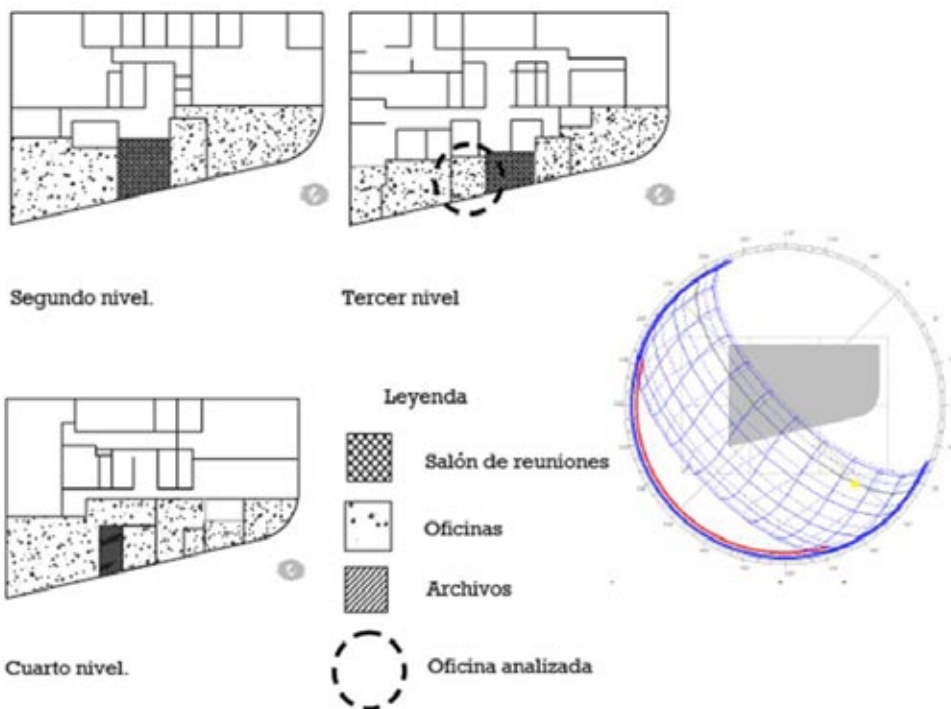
Ubicación de la oficina objeto de estudio en el esquema del edificio en planta.
